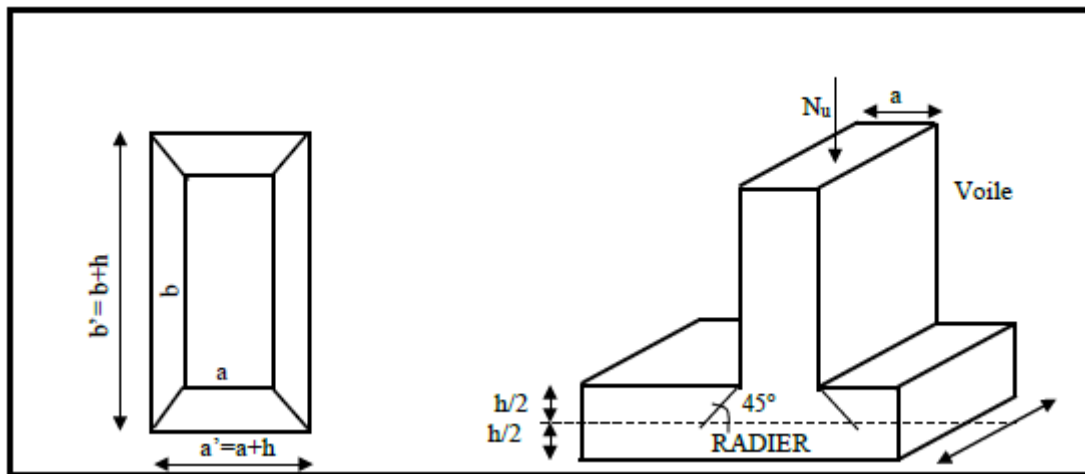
Périmètre utile des voiles et des poteaux.
